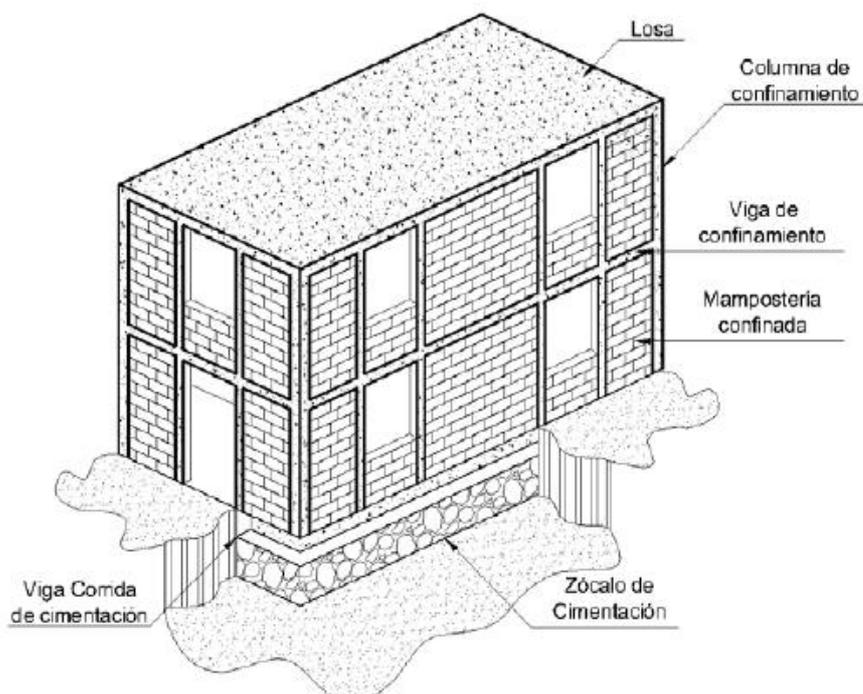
Ejemplo de muro confinado por vigas y columnas.
